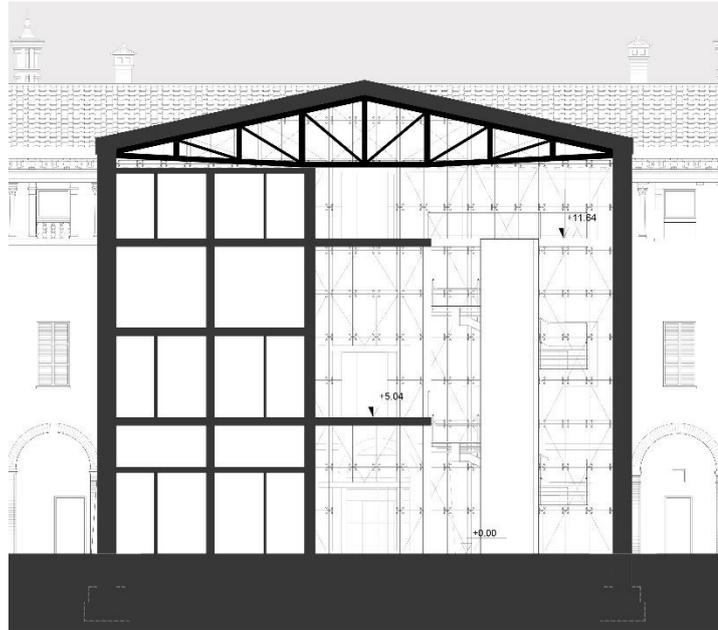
Sezione longitudinale del nuovo volume centrale. (EdA)
